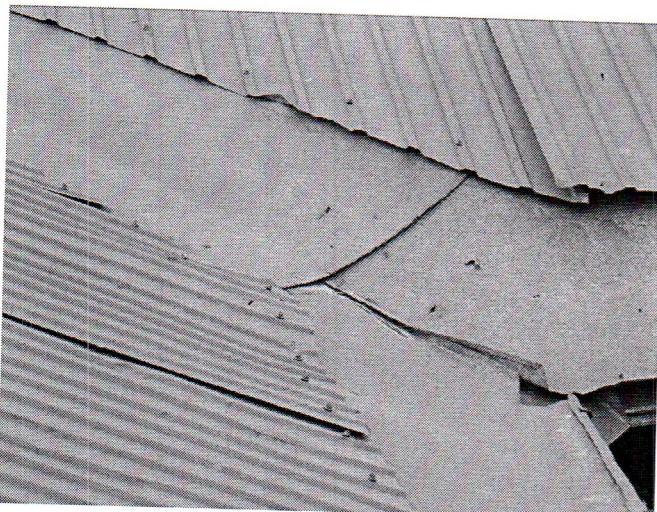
, 15. Пробоины в кровельном покрытии, нарушение соединения листов.
